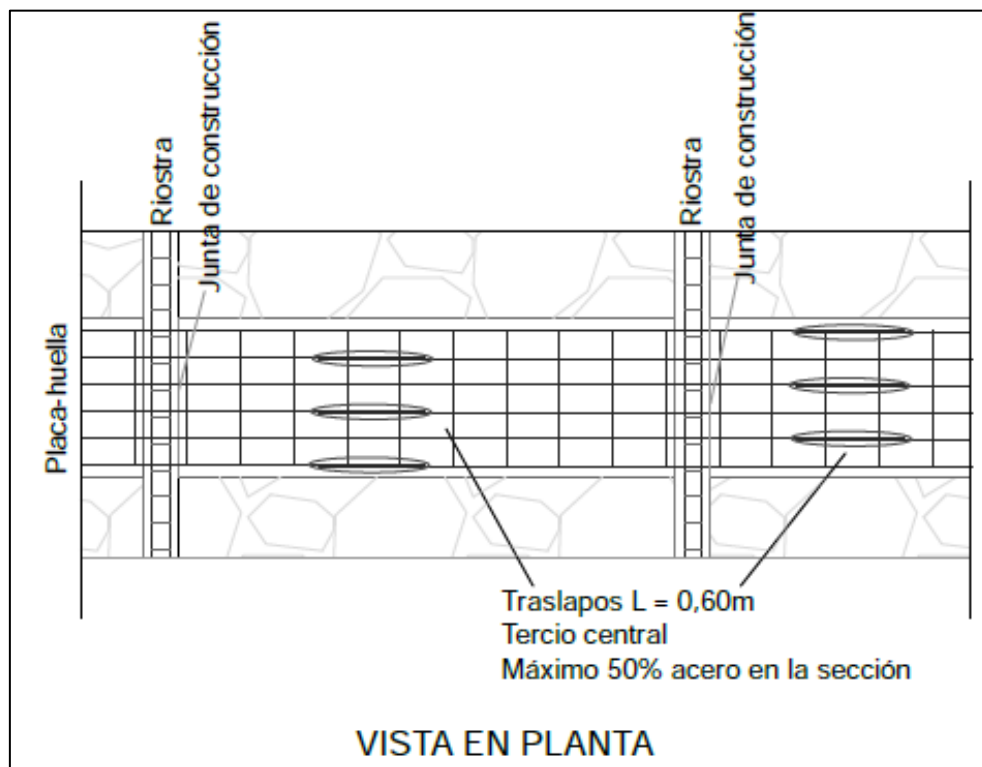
Junta transversal de construcción en la Placa-huella [3]
